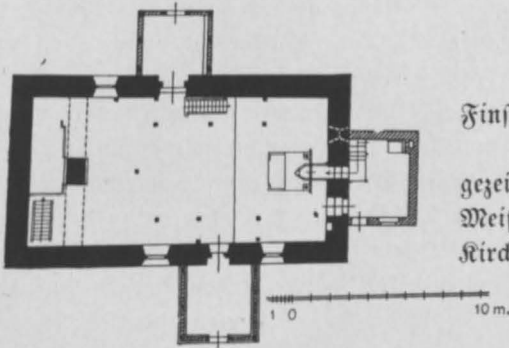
Dollnichen. Grundriss der Kirche.
